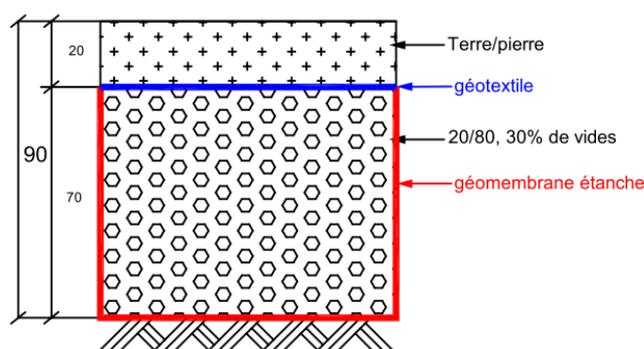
Coupe de la chaussée stockante en terre/pierre (Jardins du MeM) - Source : ORA
